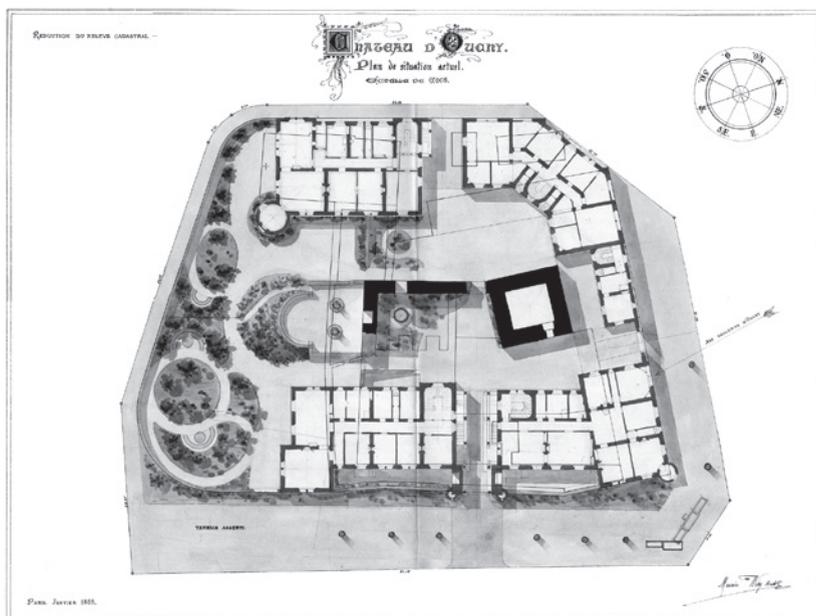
Château d'Ouchy, plan d'implantation et de distribution des bâtiments, par Maurice Wirz, janvier 1885 (dessiné sur la base du relevé cadastral) (AM).
